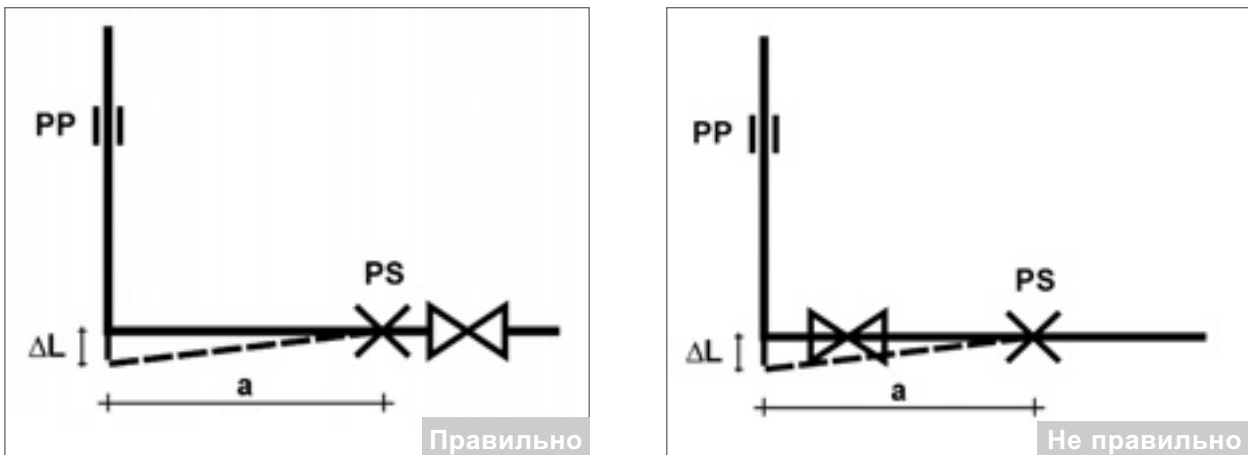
Монтаж вентилей на трубопроводе («а» - компенсирующее плечо).
